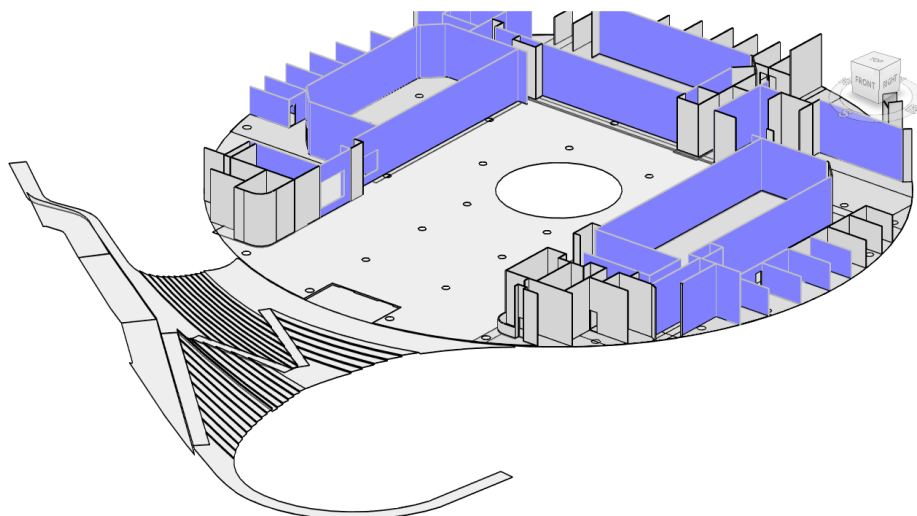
Modelado de la escalera y rampa de acceso.
